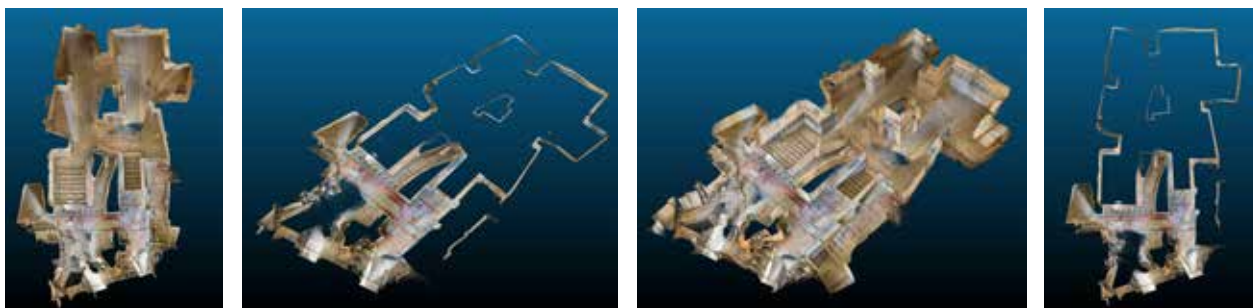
Rappresentazione di alcuni "slices" in Cloud Compare (planimetrie e viste prospettiche).
